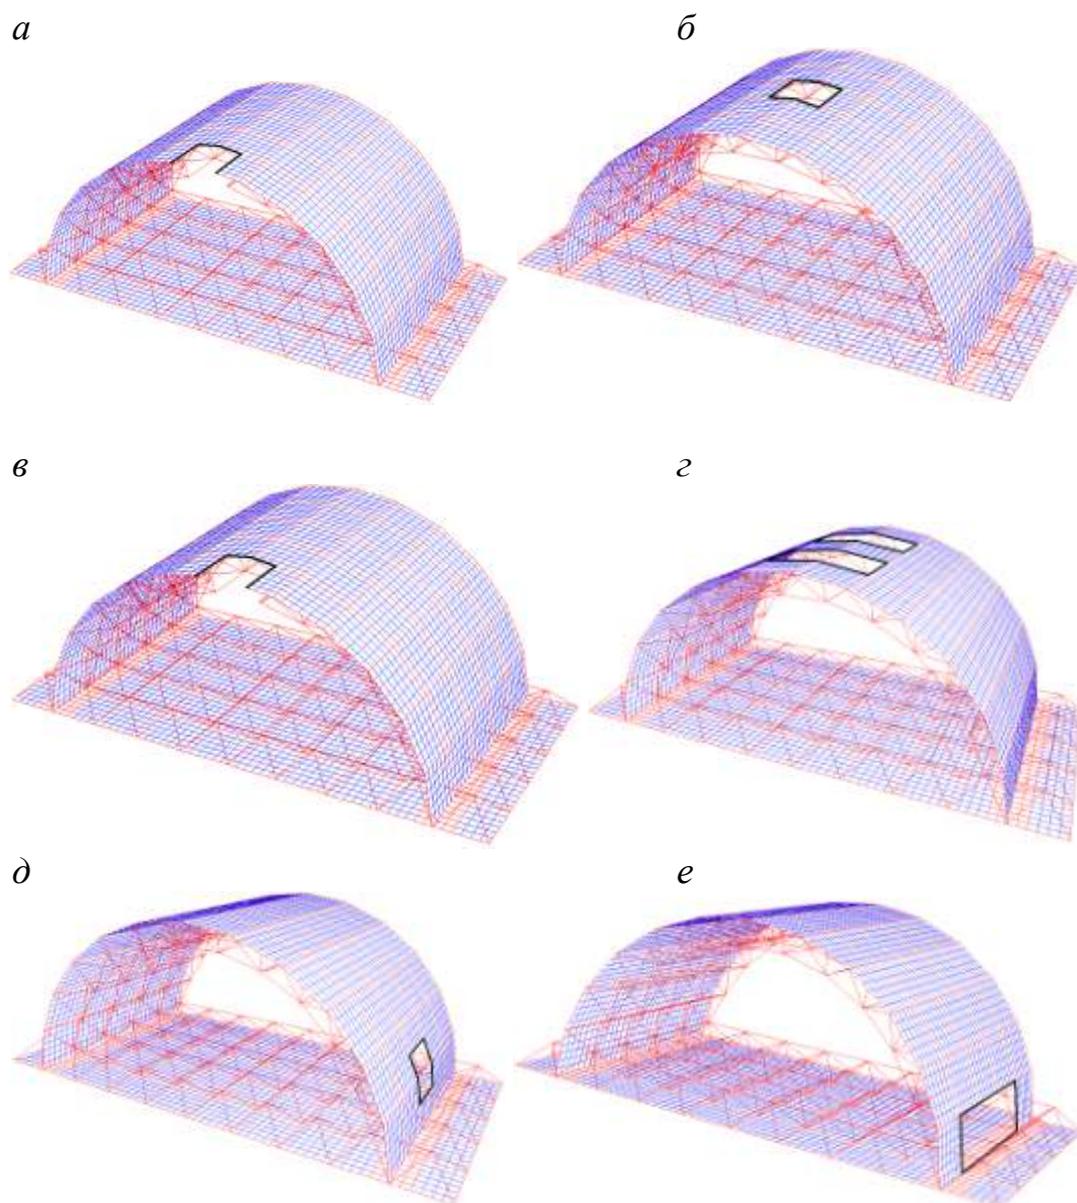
Расчетная схема здания с возможными локальными разрушениями, моделируемыми прямоугольными вырезами
